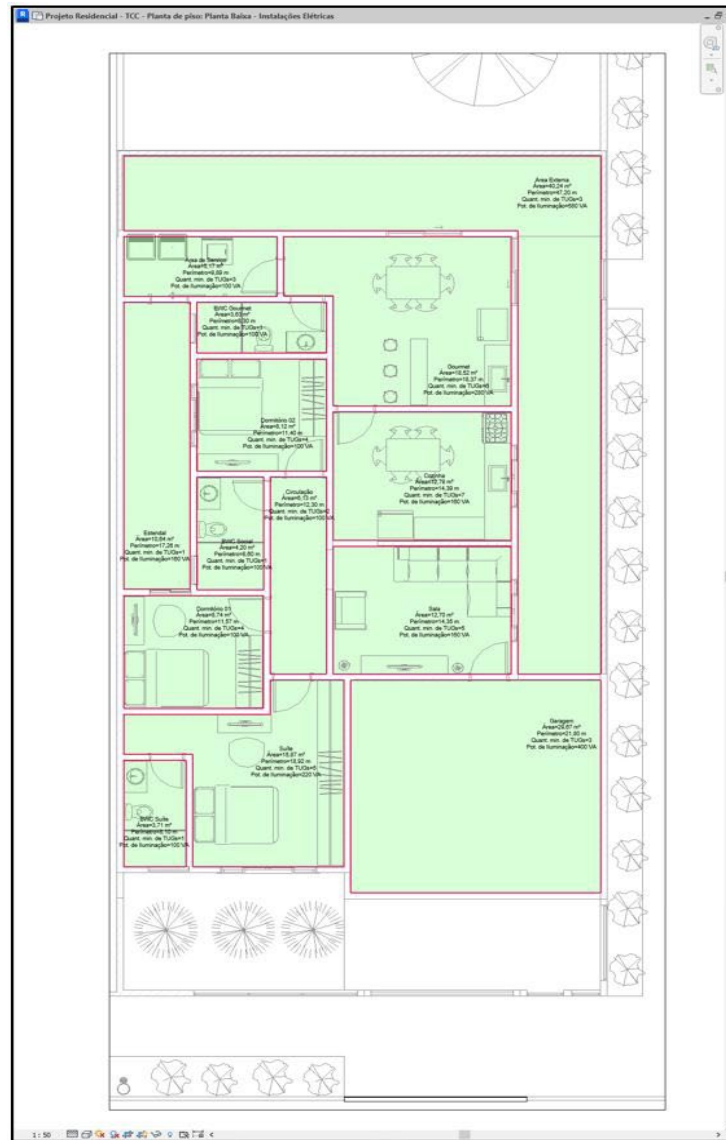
Planta baixa base para a elaboração do projeto elétrico.
